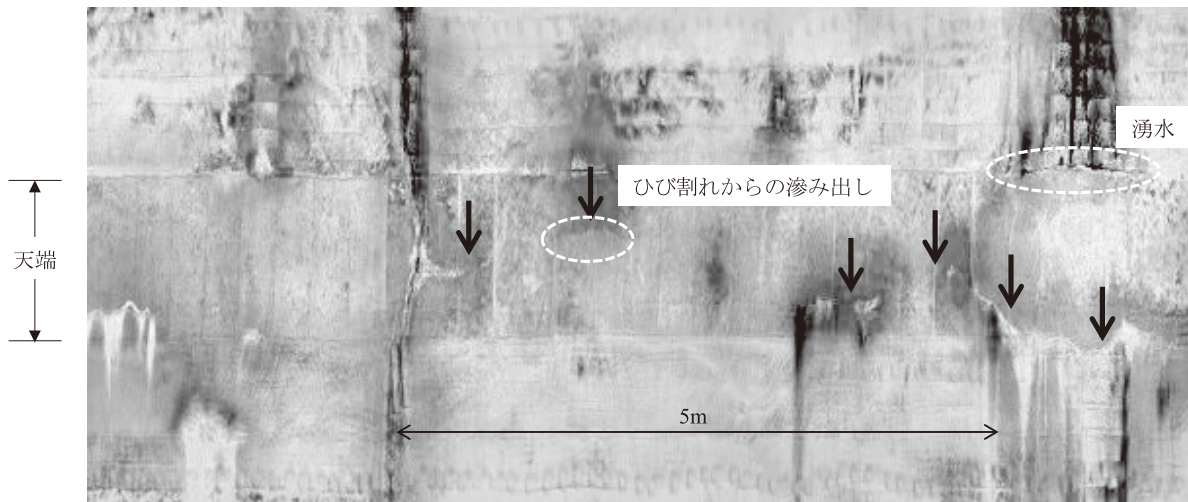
検出された幅1mm未満のひび割れ（天端部分の拡大図）
